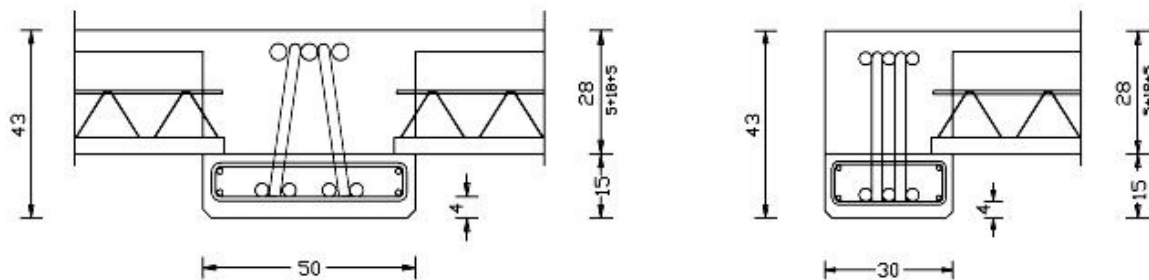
Particolare delle sezioni tipiche delle travi tipo REP utilizzate in progetto
